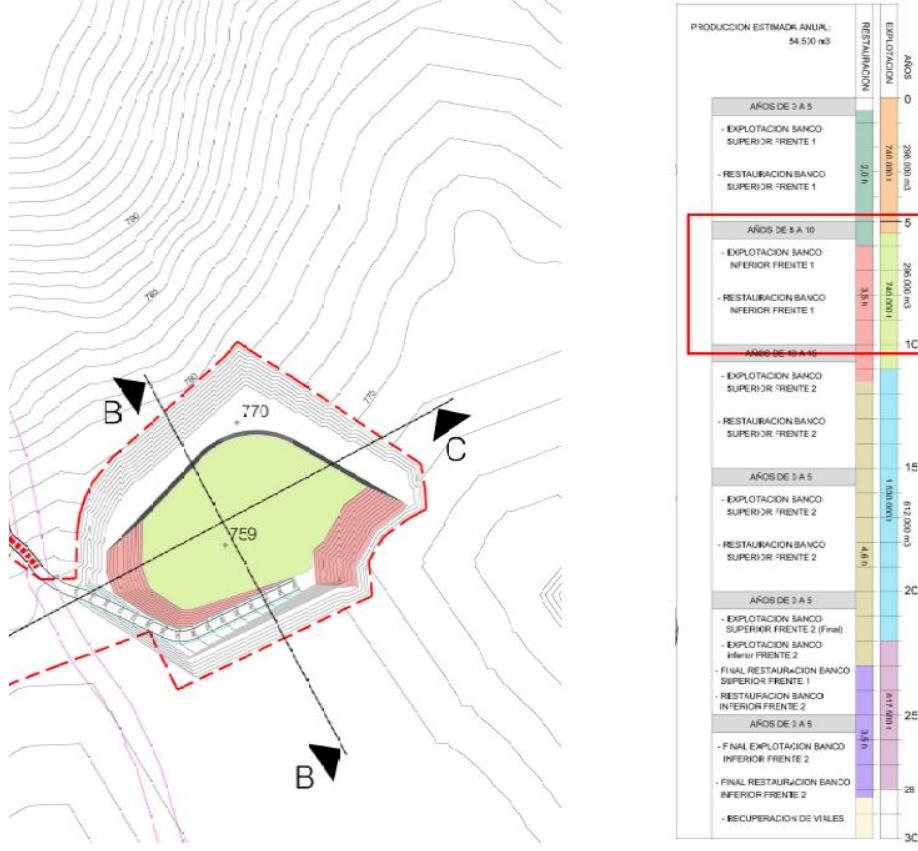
Fase 2, de explotación y restauración en el año 10. Plano correspondiente a Plano 3. Hoja 2.
